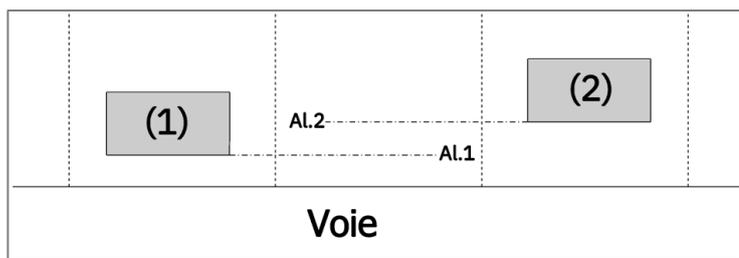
Appréciation d'un alignement dominant. La façade principale de la construction à édifier entre les constructions existantes (1) et (2) doit s'inscrire entre Al.1 et Al.2.
